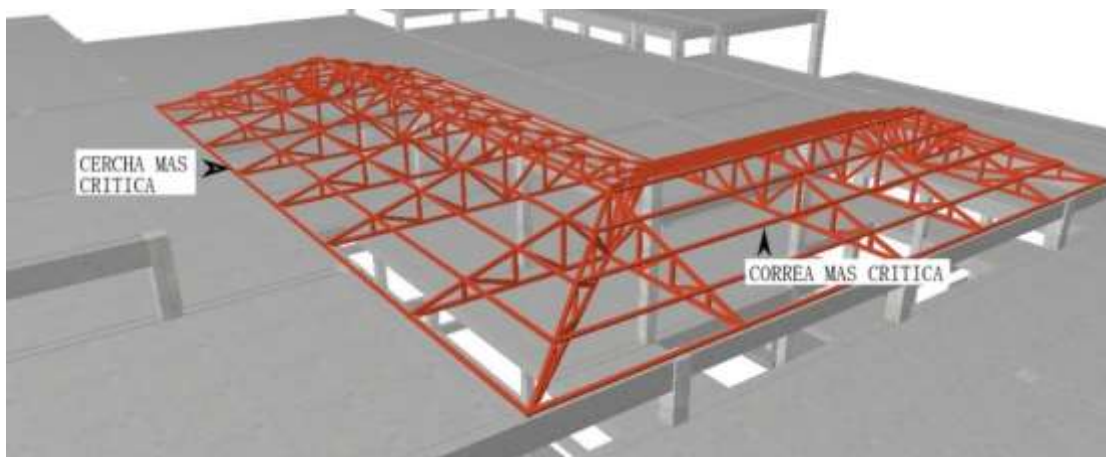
Vista superior Cubierta Metálica, Fuente: CypeCad 2017
